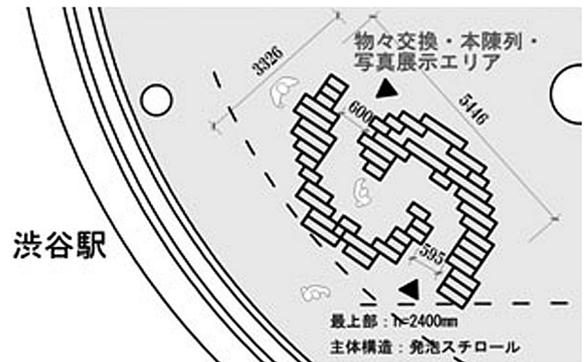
渋谷ヒカリエ 4F アーバンコア展示 平面図
